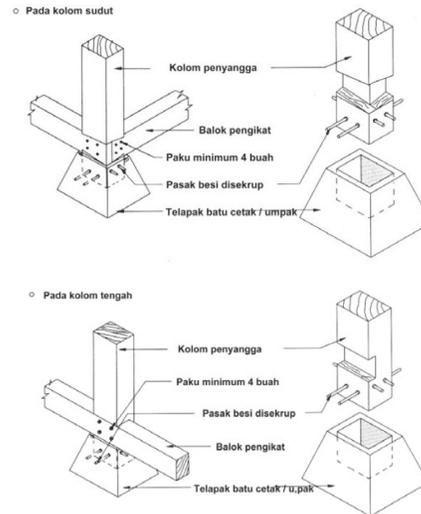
Detail sambungan kolom pondasi dengan balok pengikat pondasi
